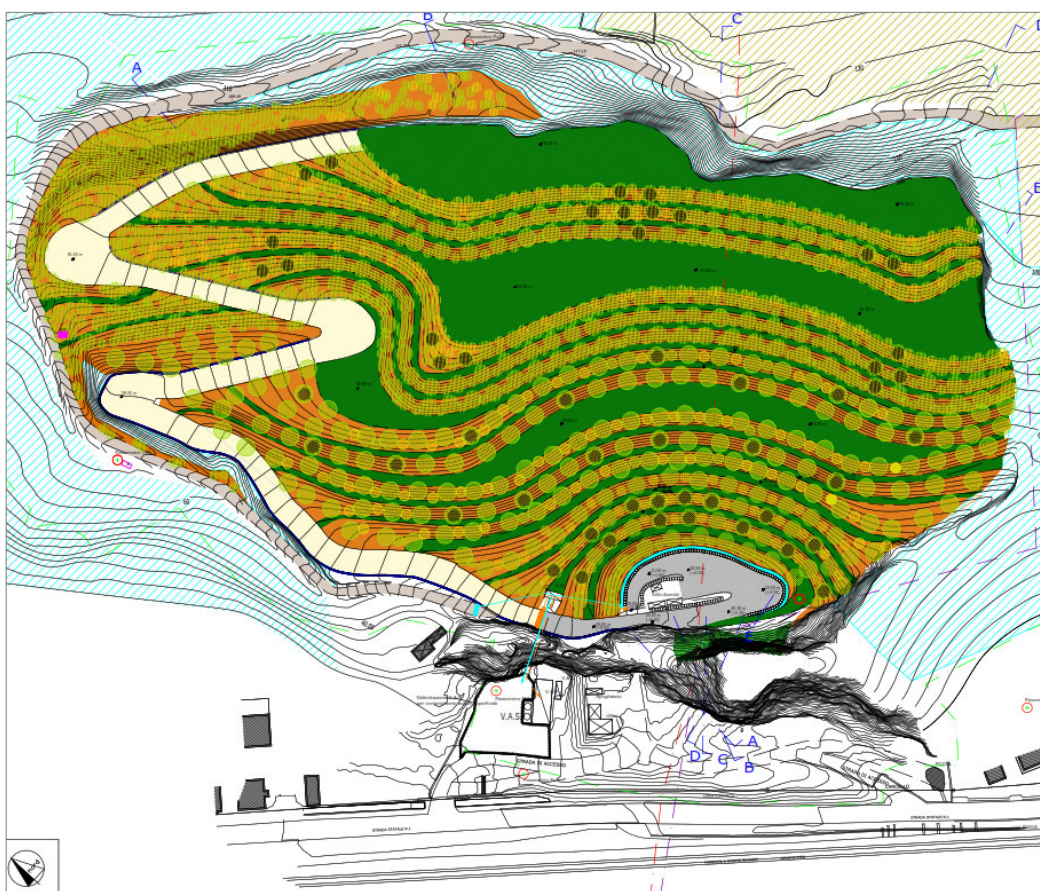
Estratto planimetria del piano di ripristino ambientale finale
